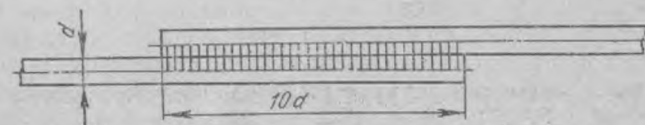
Соединение стальных проводов сваркой
